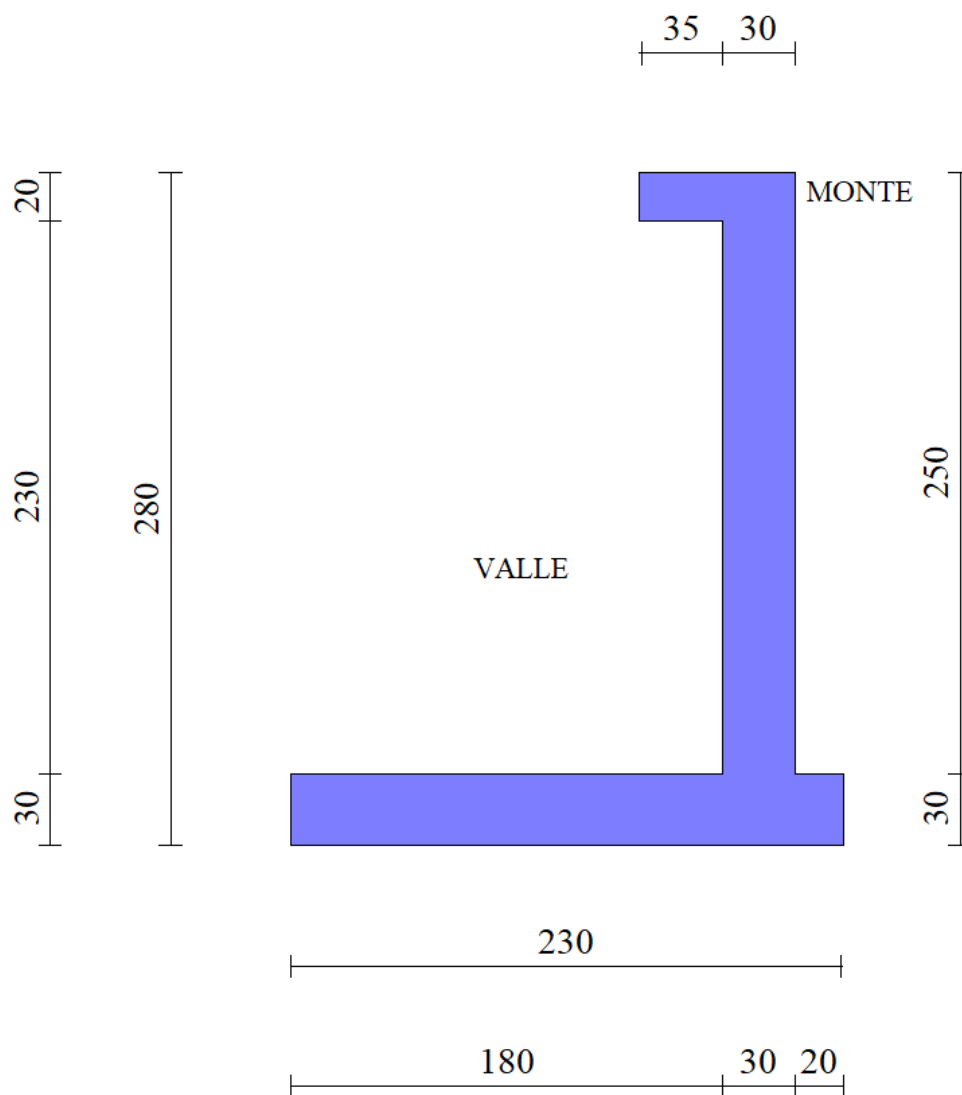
Estratto dal software di calcolo MAX 16.0 – Geometria di modellazione in sezione
